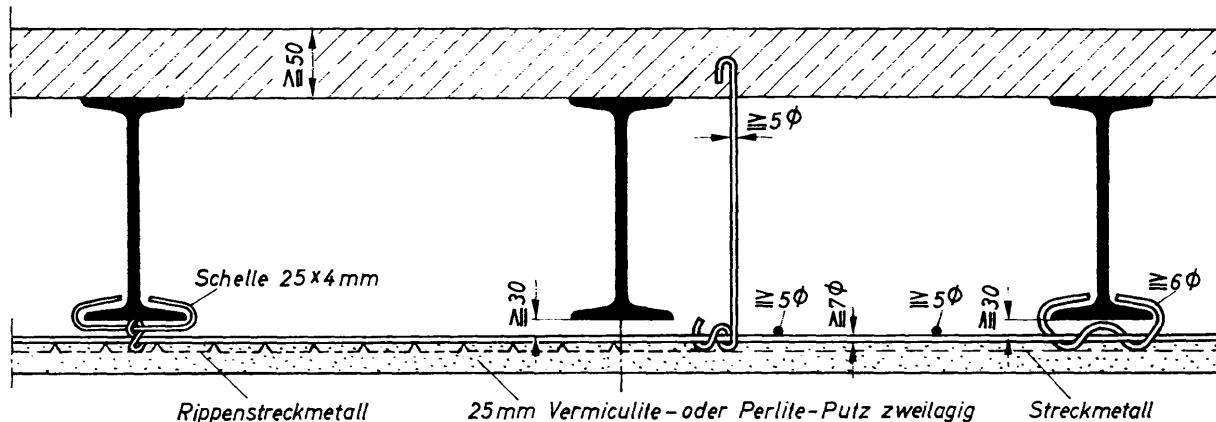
Feuerbeständige Stahlträgerdecke mit Drahtputzdecke und Aufhängungen nach DIN 4121
